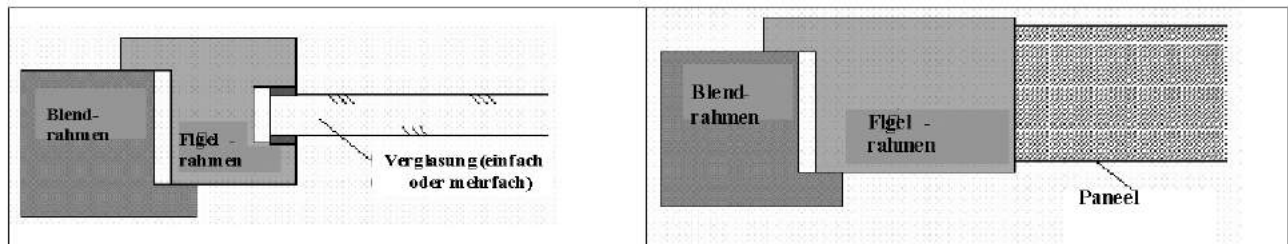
Darstellung eines Einfachfensters/einer Einfachtür
